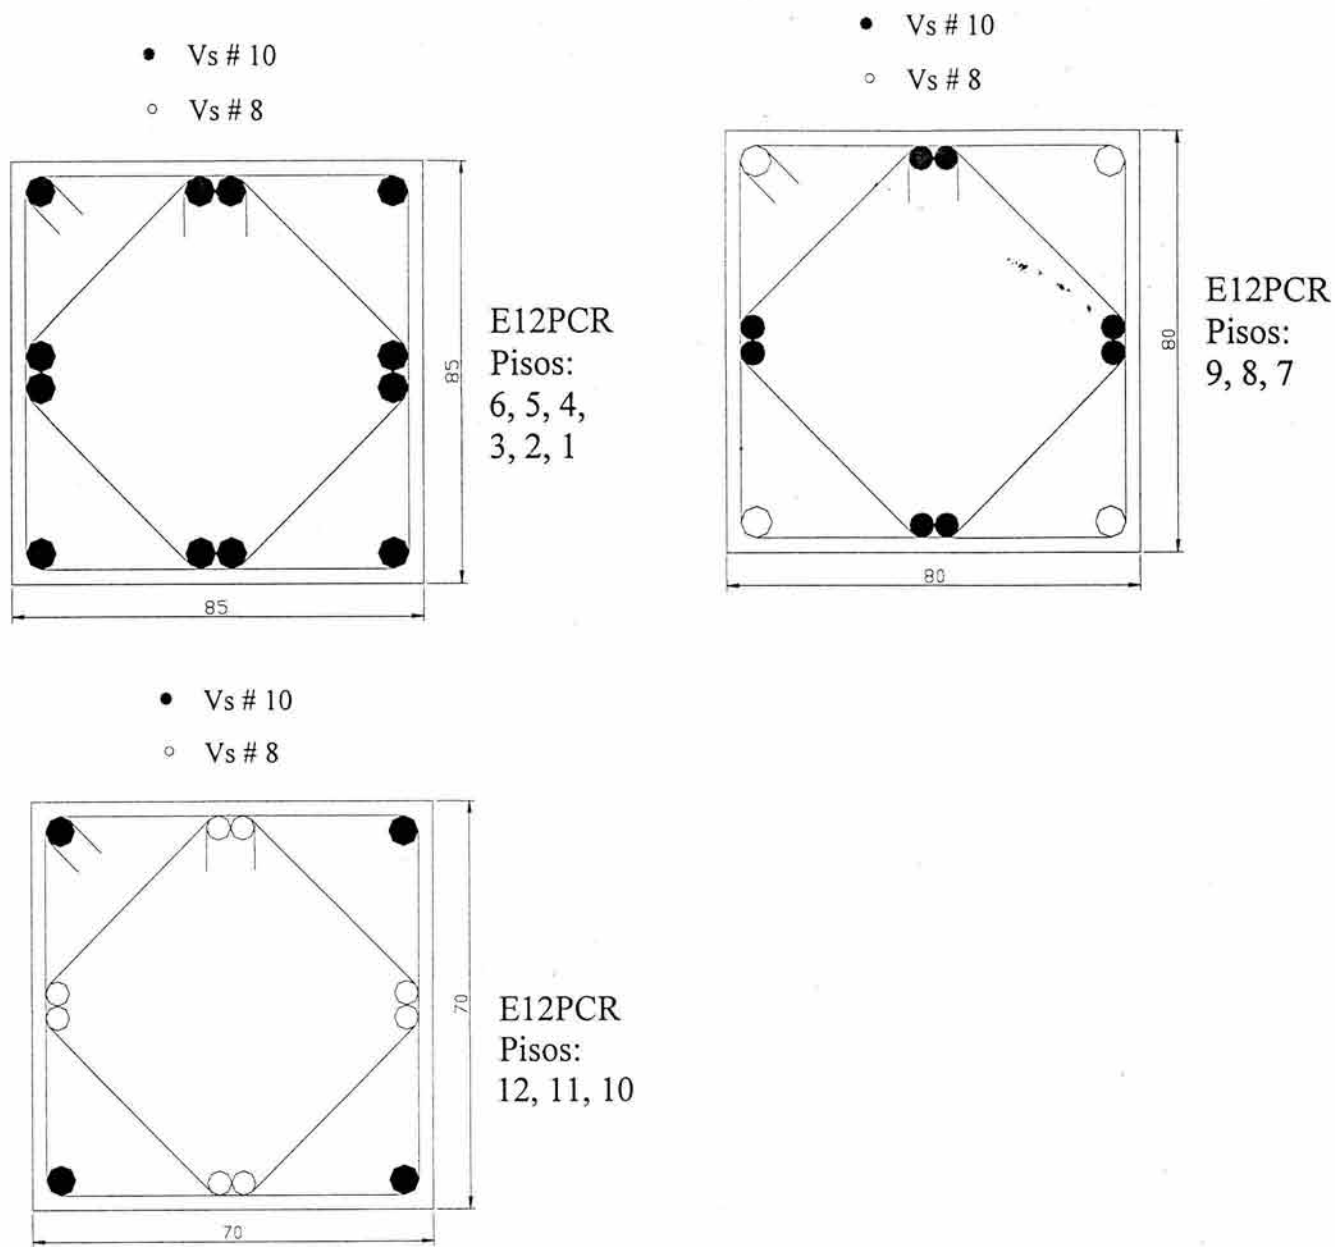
Detallado de columnas en edificio de 12 niveles, marcos interiores.
